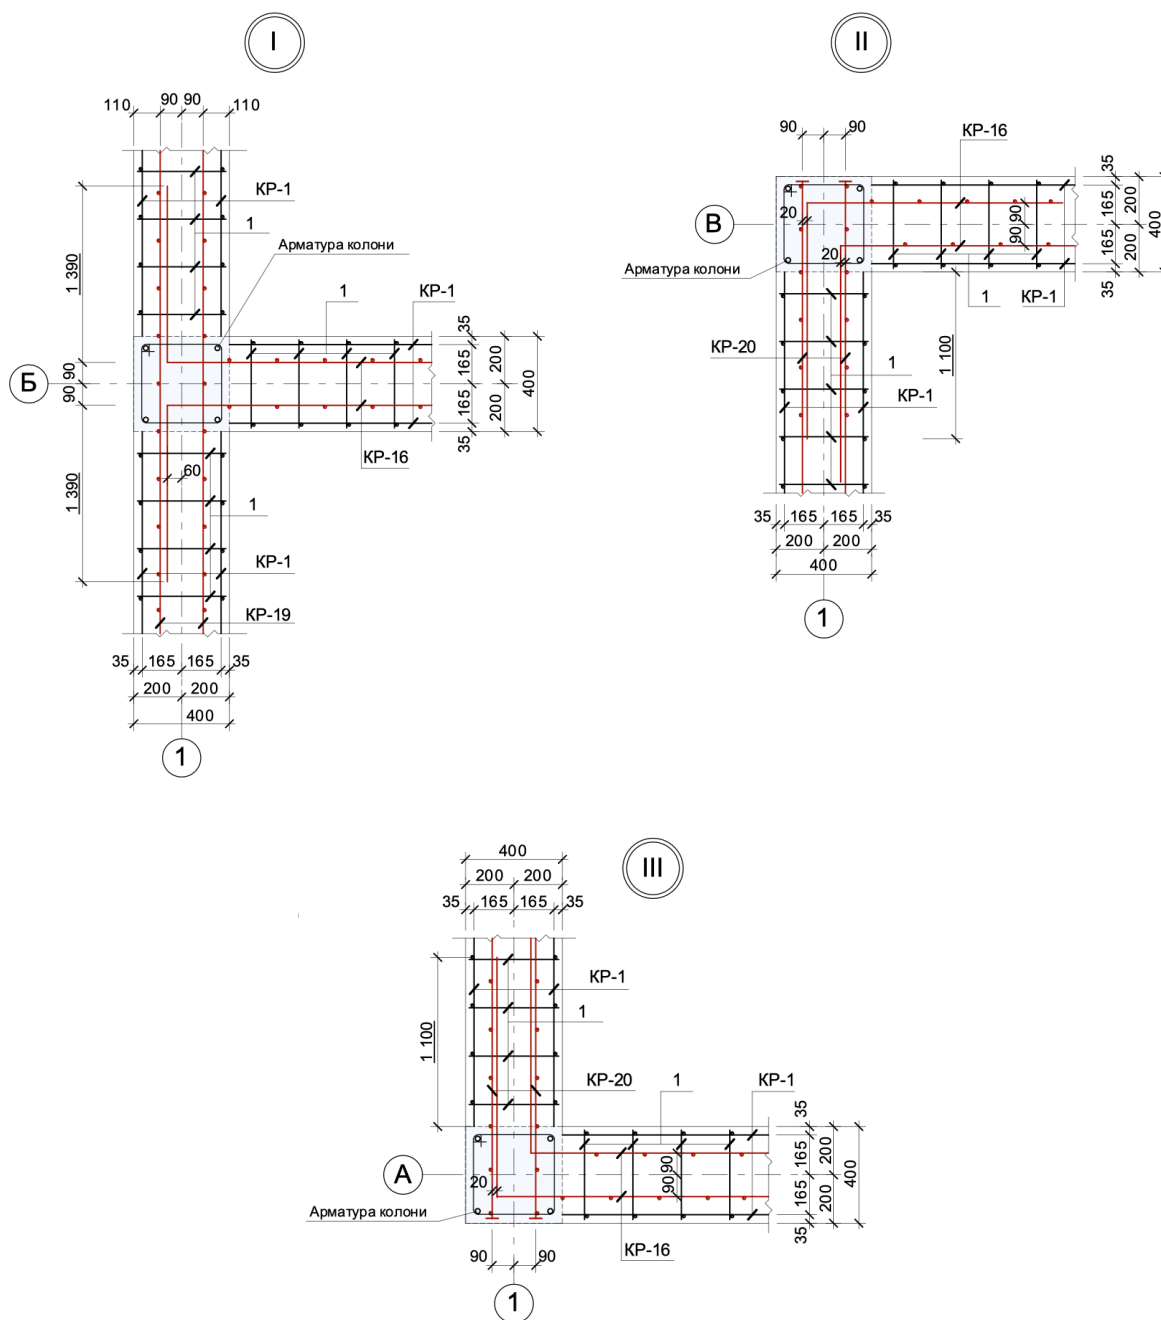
Схема розташування монолітних балок перекриття
